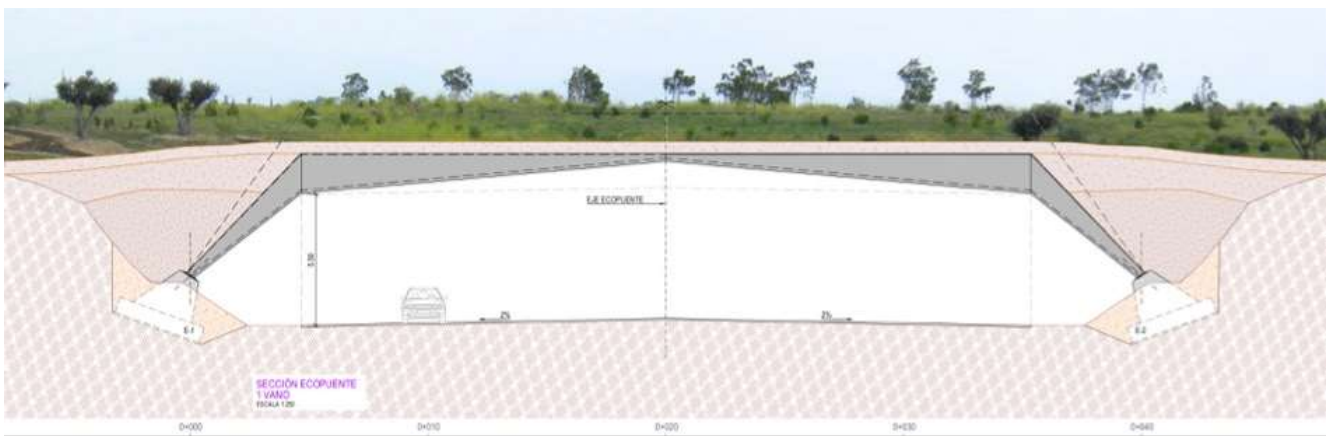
Alzado de Ecopuente simple para longitud de hasta 35m (1 vano)
